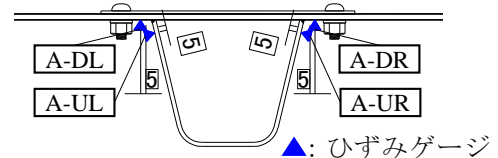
ひずみゲージ貼り付け位置 (単位: mm)
